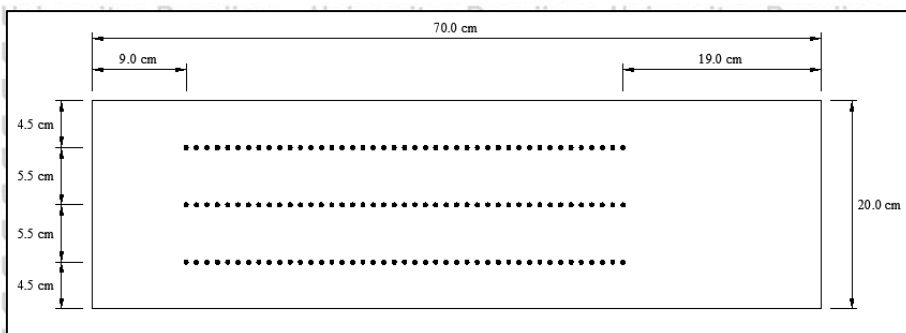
Skema pengujian A scan benda uji balok dengan lubang arah transversal
